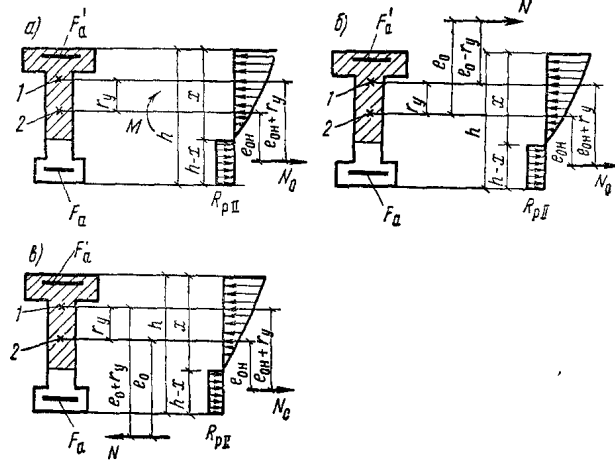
Схемы усилий и эпюры напряжений в поперечном сечении элемента при расчете его по образованию трещин, нормальных к продольной оси элемента, в зоне сечения, растянутой от действия внешних нагрузок
